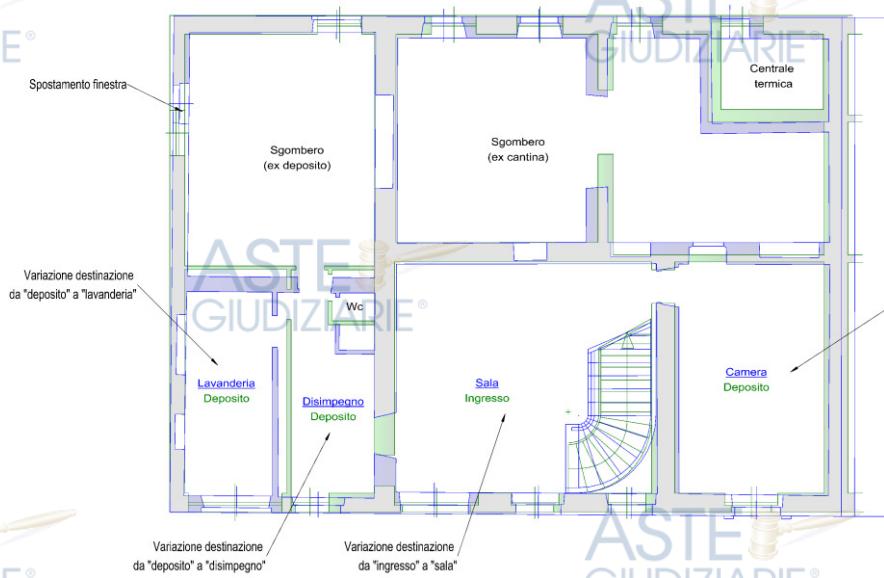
Estratto Tavola di Confronto fra rilievo stato di fatto e tavola di Conc. Sanatoria 1517/86 – Pianta piano terra
